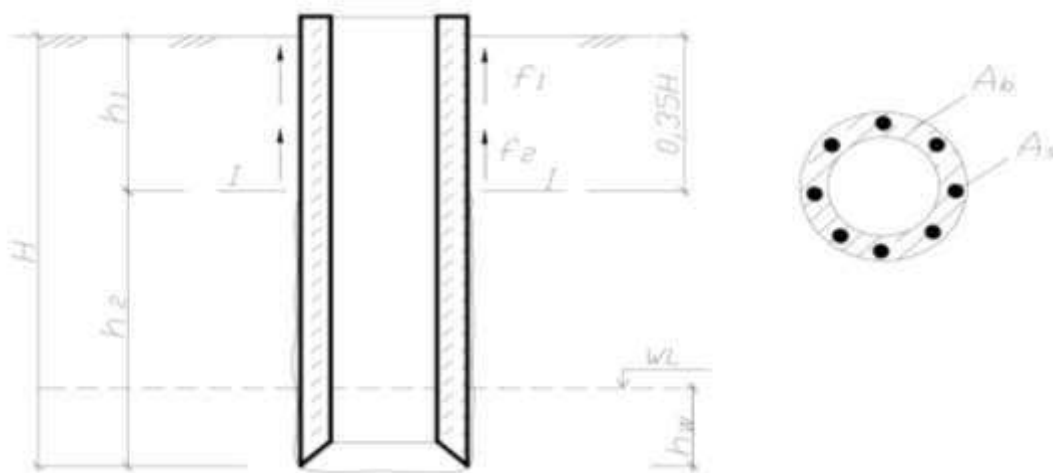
Схема к расчету опускного колодца на разрыв
